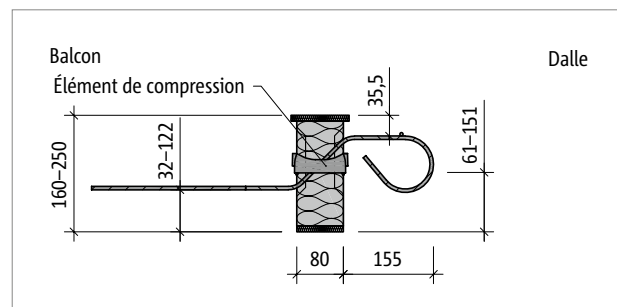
Schöck Isokorb® T types Q-T-W-V1 à V2 : coupe du produit
